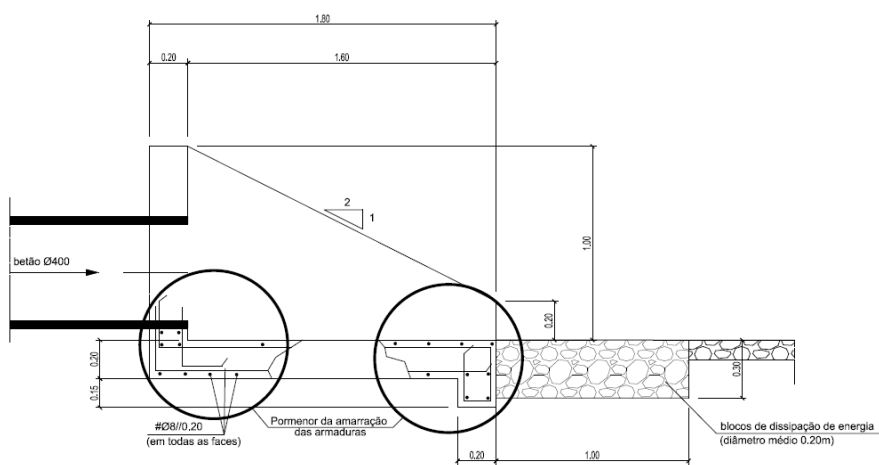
Corte longitudinal tipo da descarga em boca de lobo
